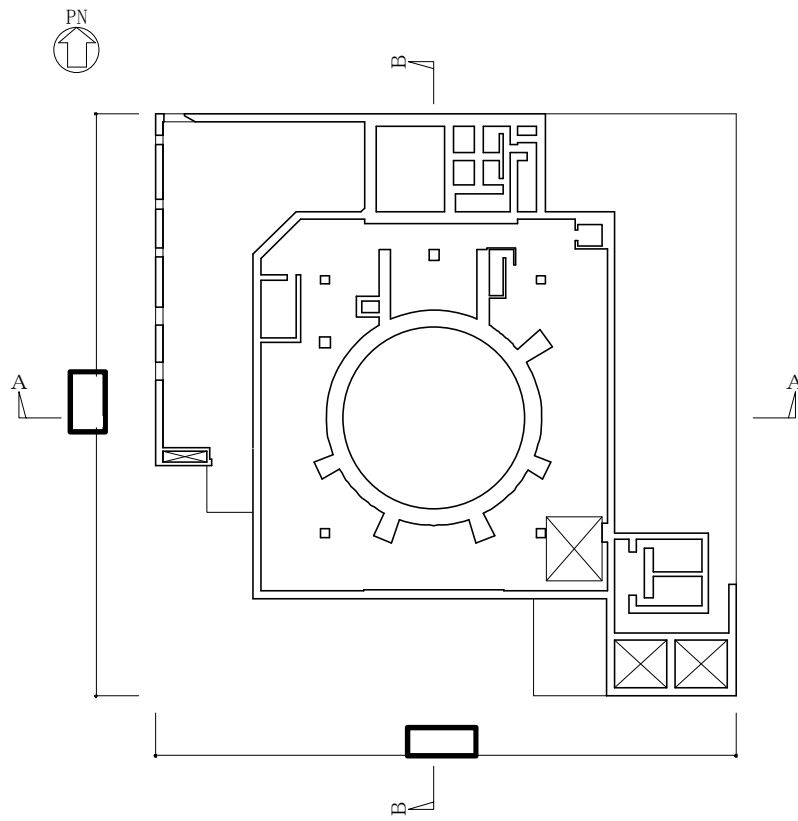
(5/9) の概略平面図 (EL. 20.3 m)
